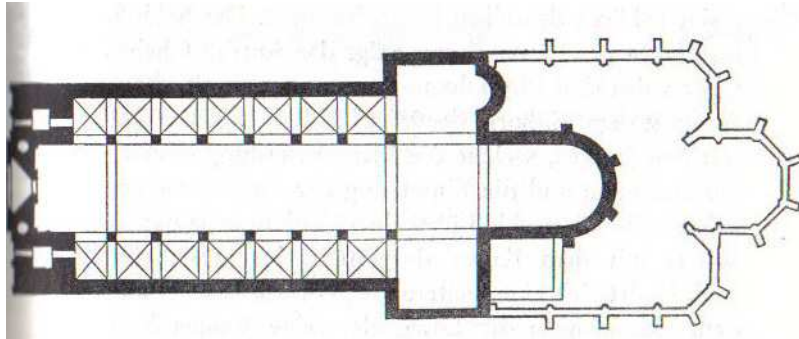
Schematischer Grundriss von St. Stephan II mit Umriss
